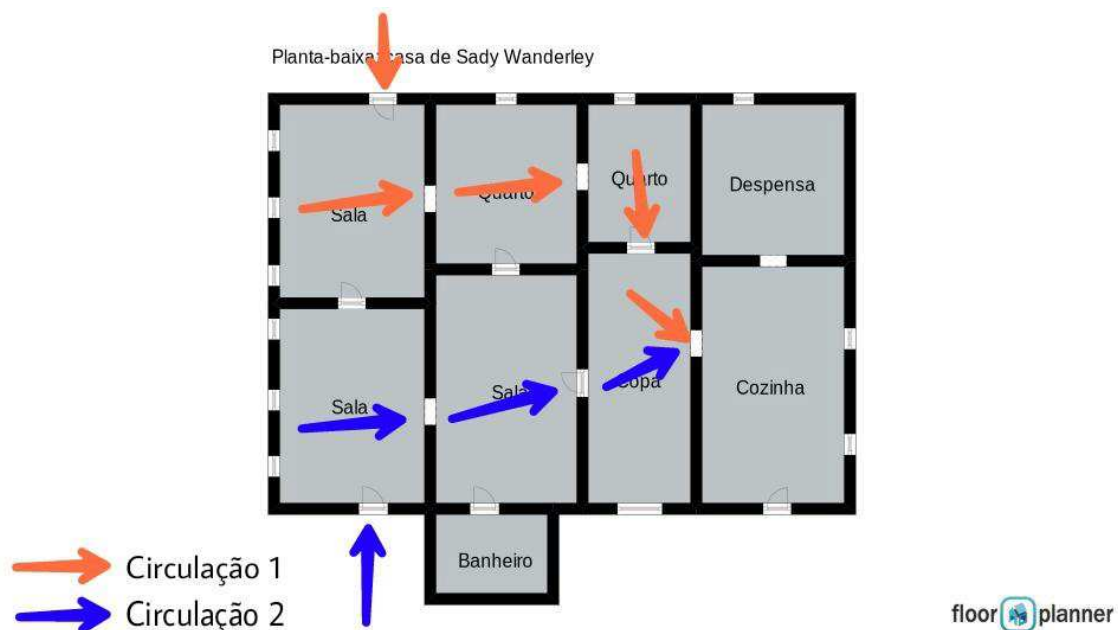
Exemplificação das opções de circulação na Casa de Sady Wanderley. Construção do autor. Fonte: Floorplanner e PicsArt.
